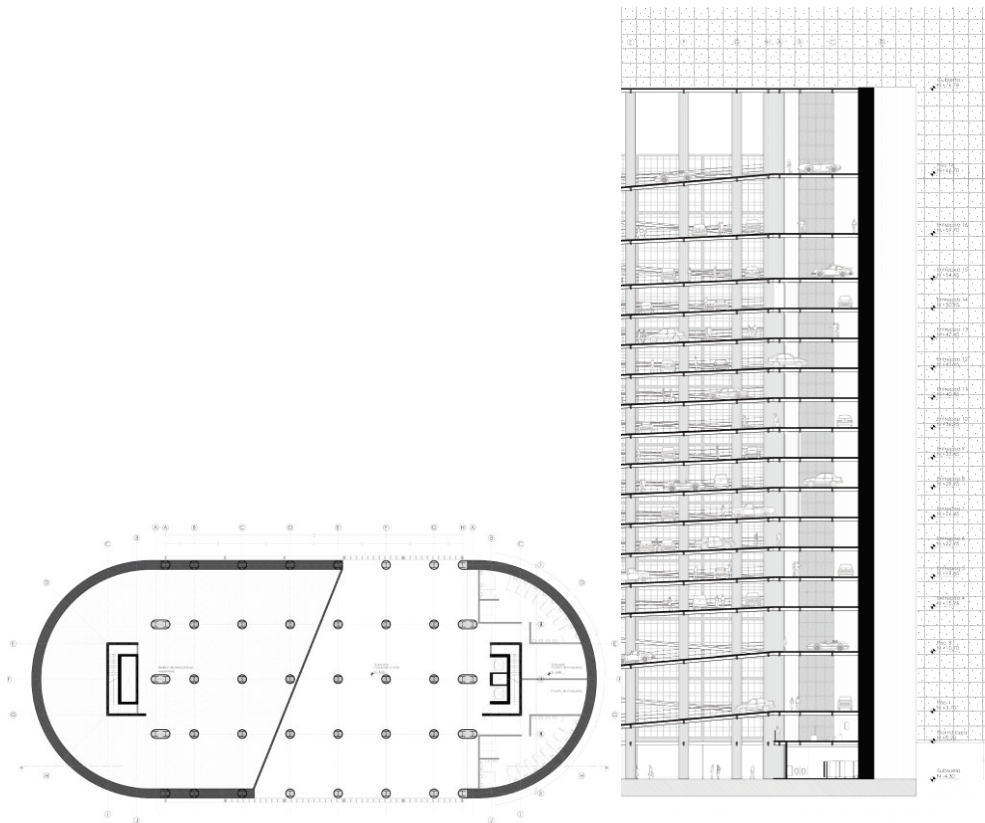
Relación entre planta baja, subsuelo y sección de la torre de aparcamiento (Buenaño, 2020)
